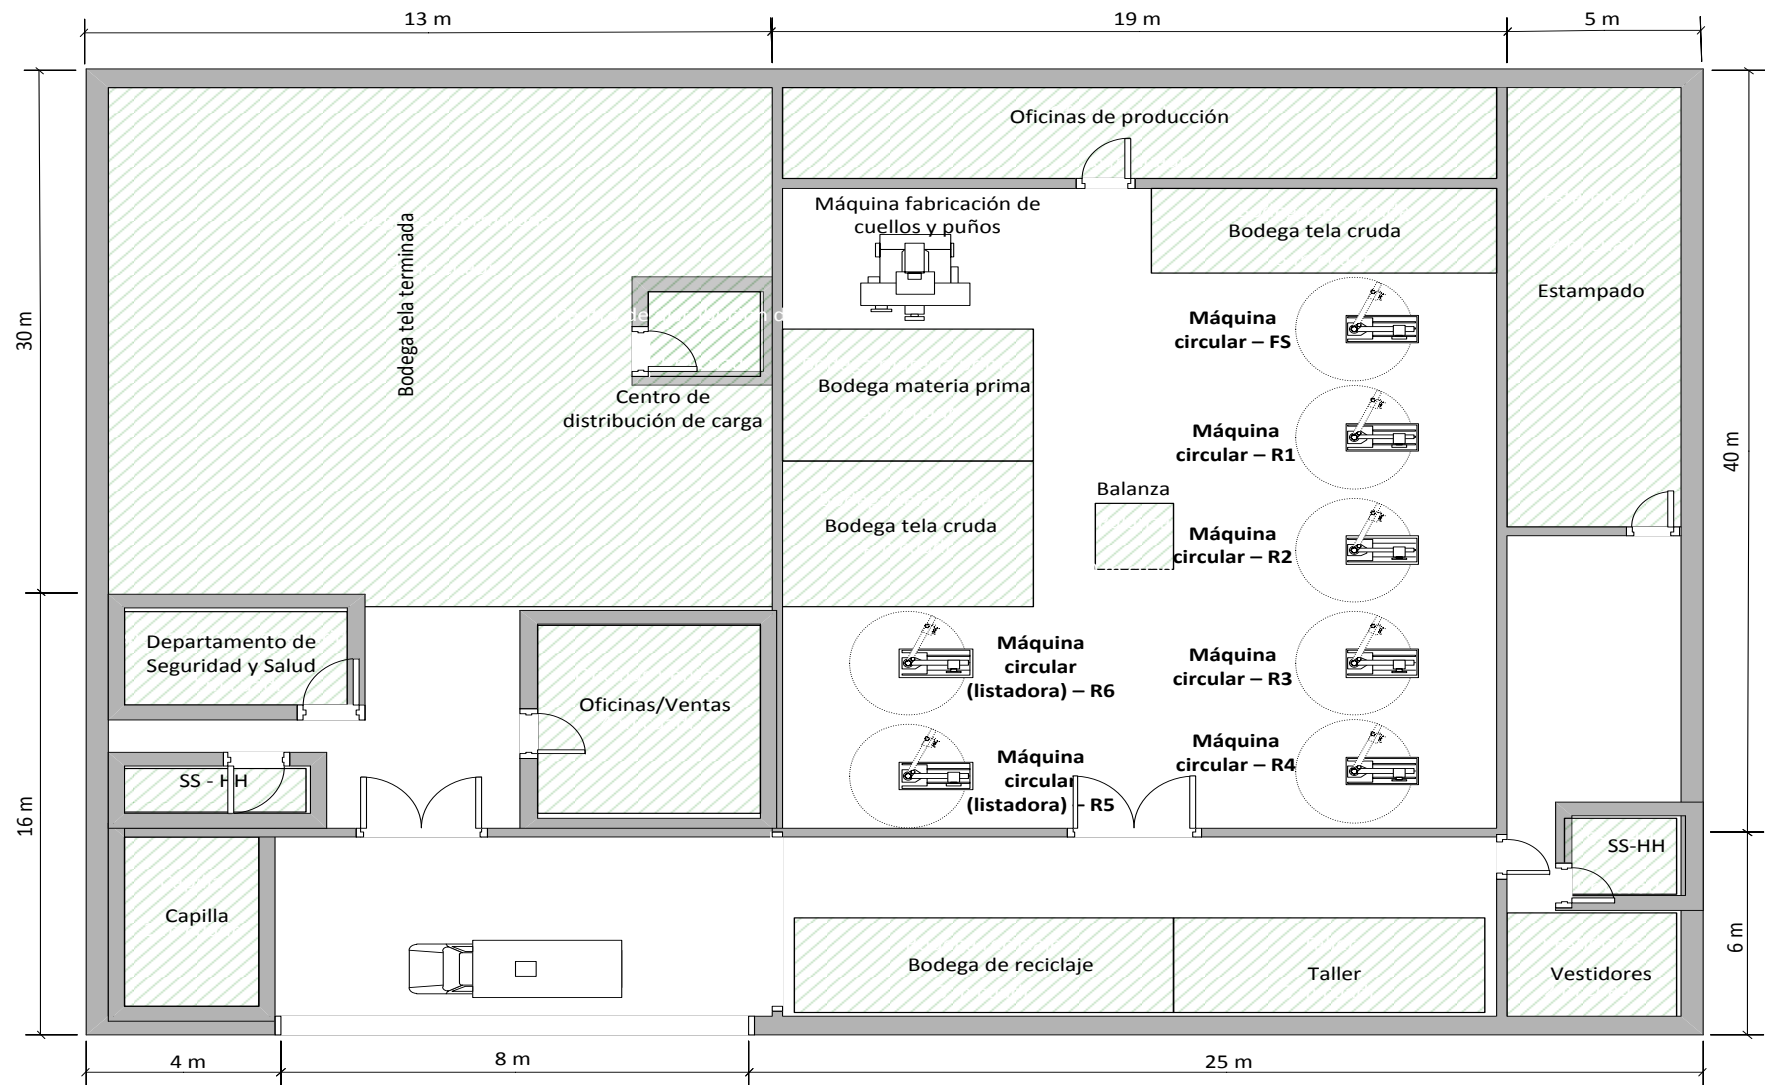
Distribución de planta tejeduría Textiles Jhonatex.
